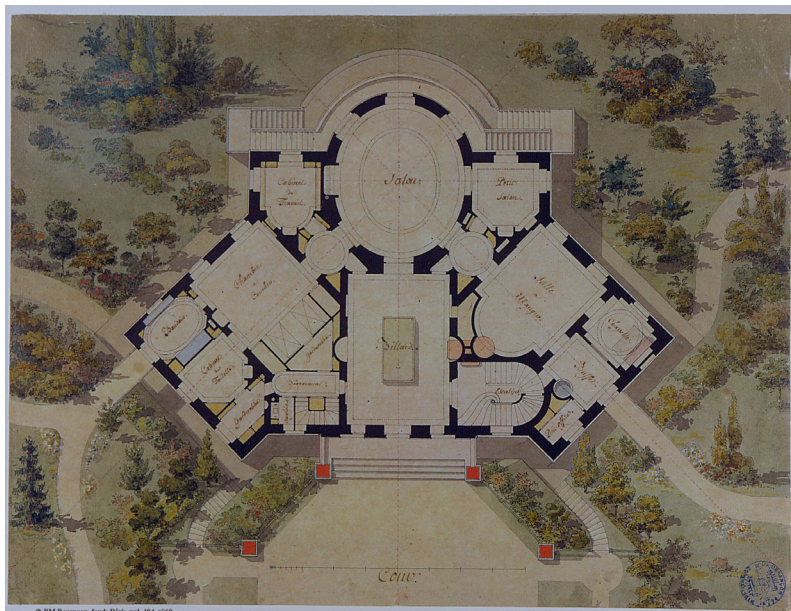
Pierre-Adrien Pâris, Plan du rez-de-chaussée du château de Colmoulin, BMB vol. 484 n° 60. © BM Besançon.
